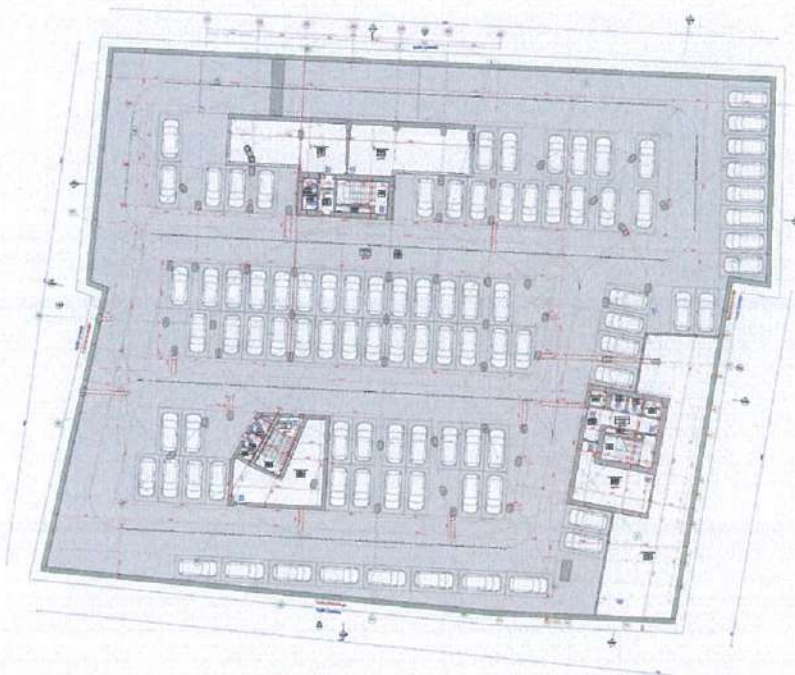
Planimetria e kateve nëntokë (-1)
